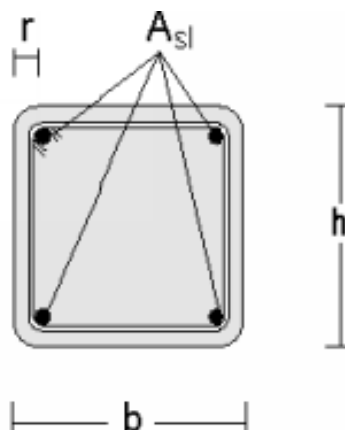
Pormenor demonstrativo do pilar retangular (S&P Colonna)
